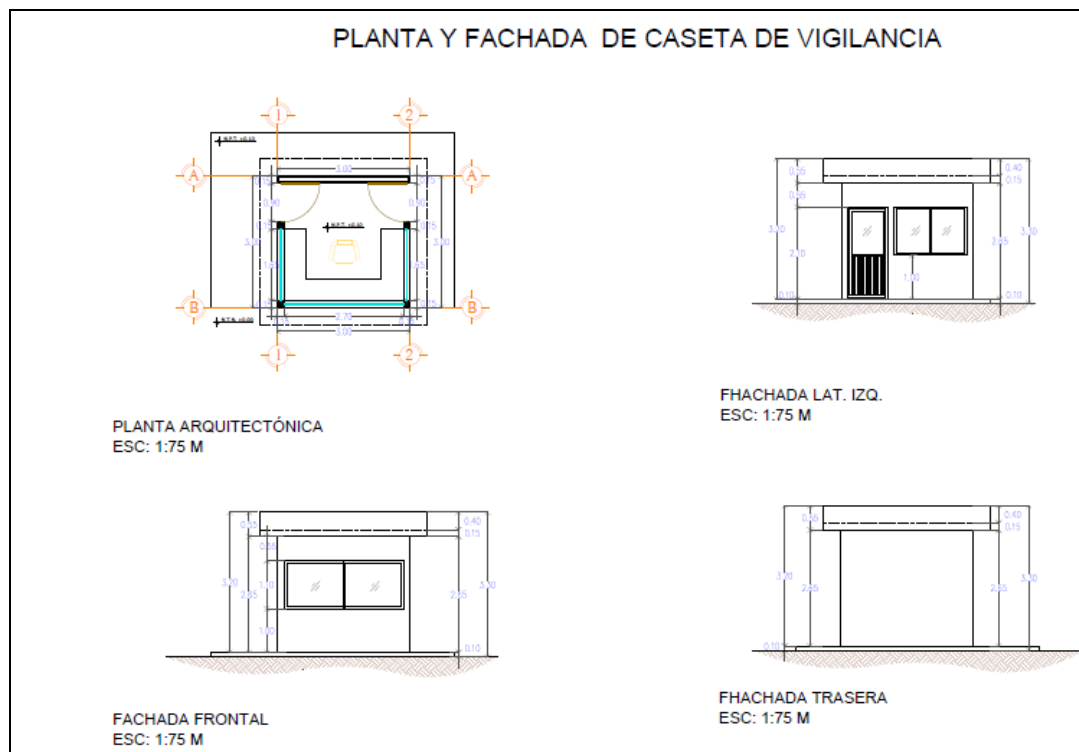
Dimensiones del área de la caseta de vigilancia. Ver detalles en Plano 6.
